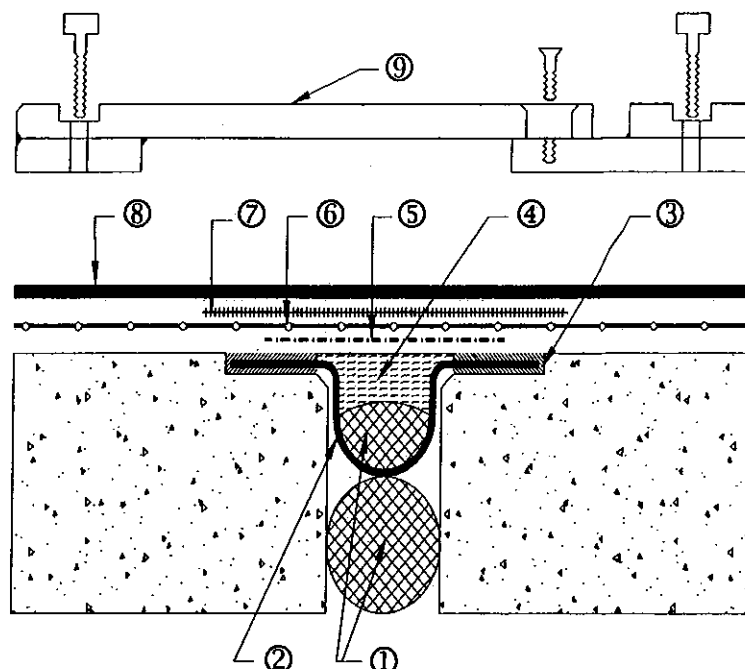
Joint de construction ou de dilatation de faible amplitude : (avec bande élastomère de pontage)
